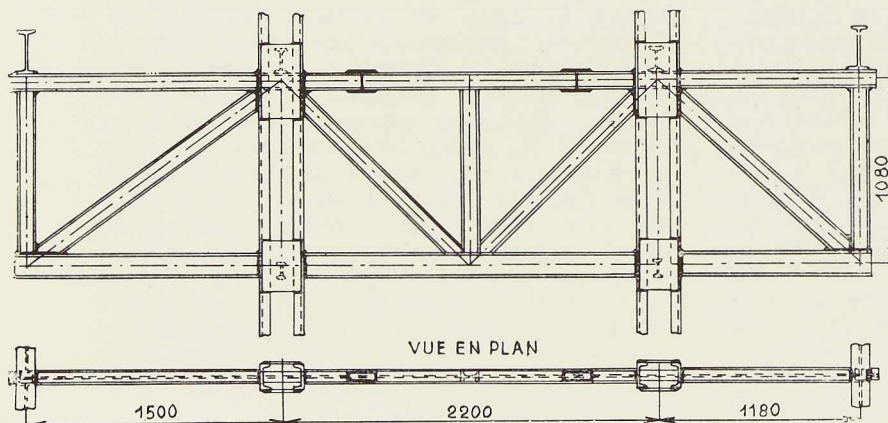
Poutre en treillis léger séparant les ailes nord et sud des ailes est et ouest.
